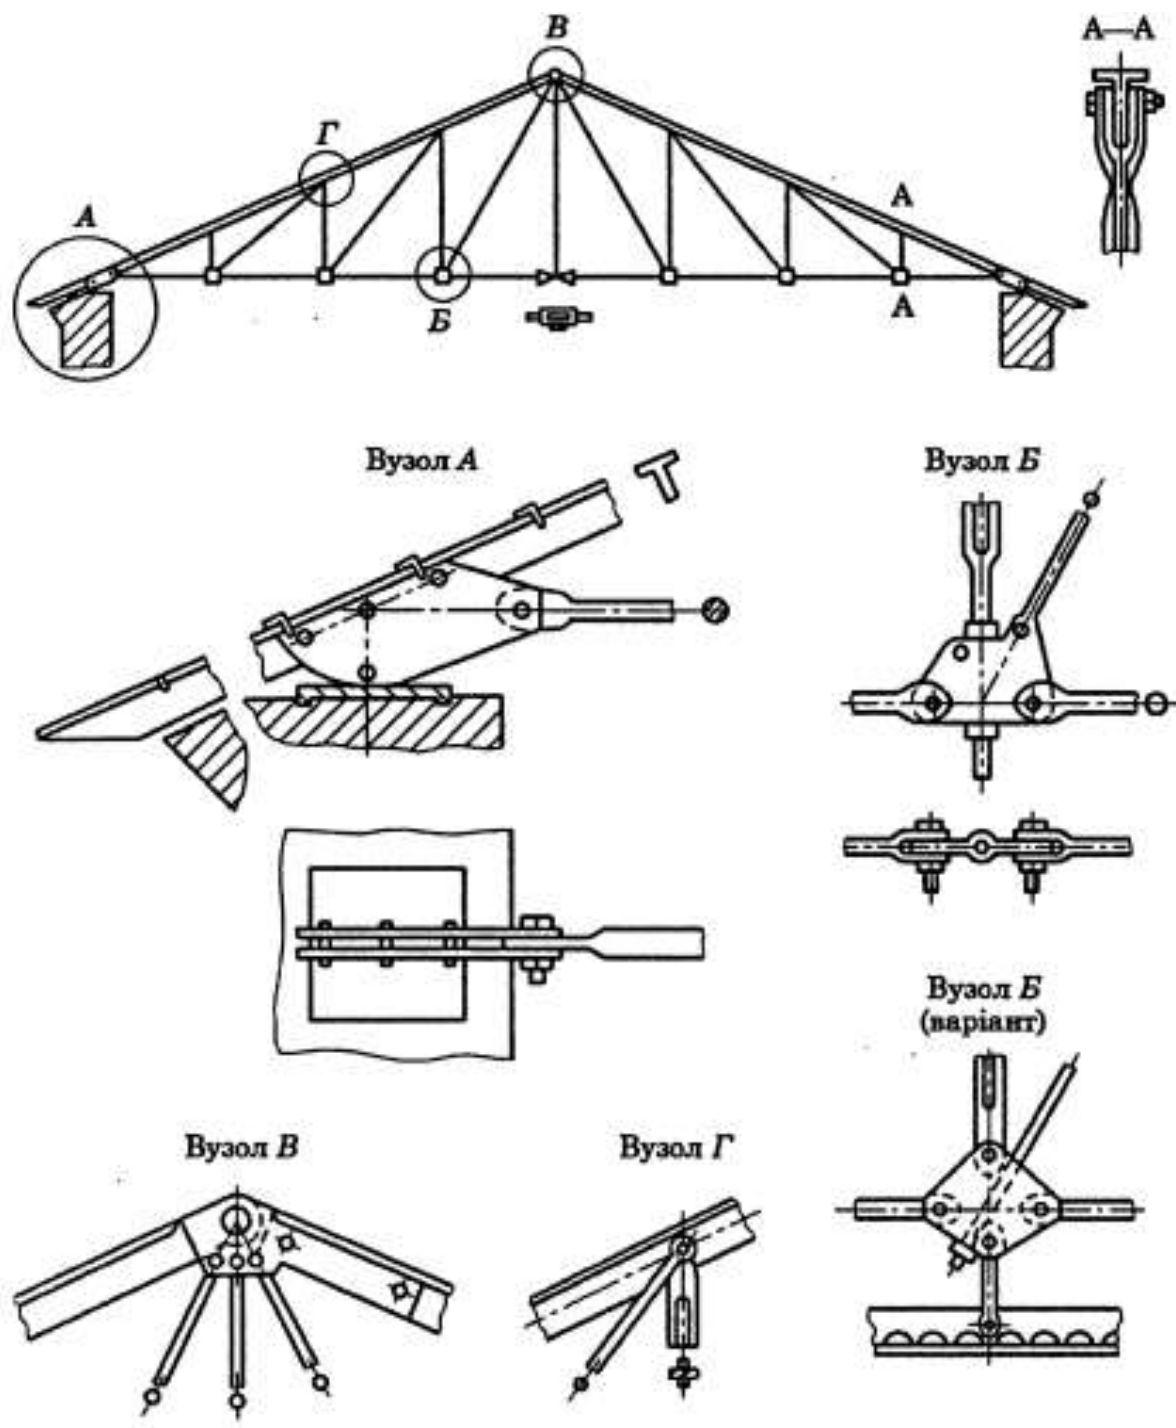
Кровляна ферма (70-ті роки XIX ст.) [9]
